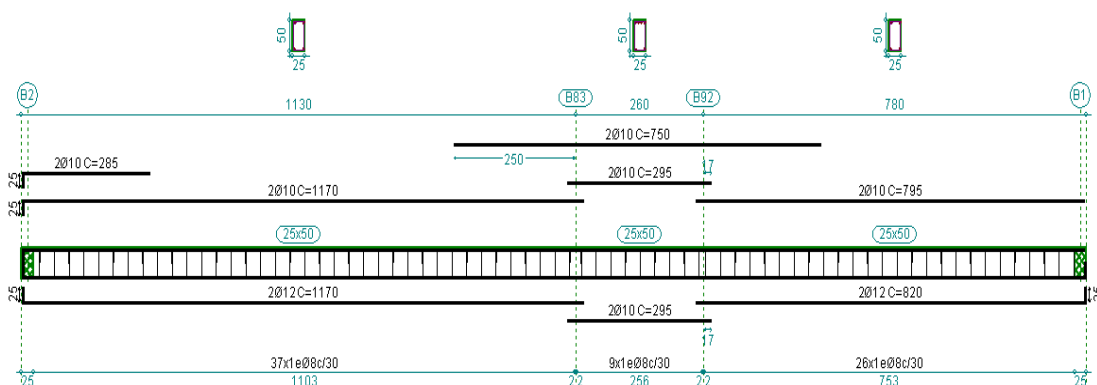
PORMENOR DAS ARMADURAS NAS VIGAS (CYPE)
